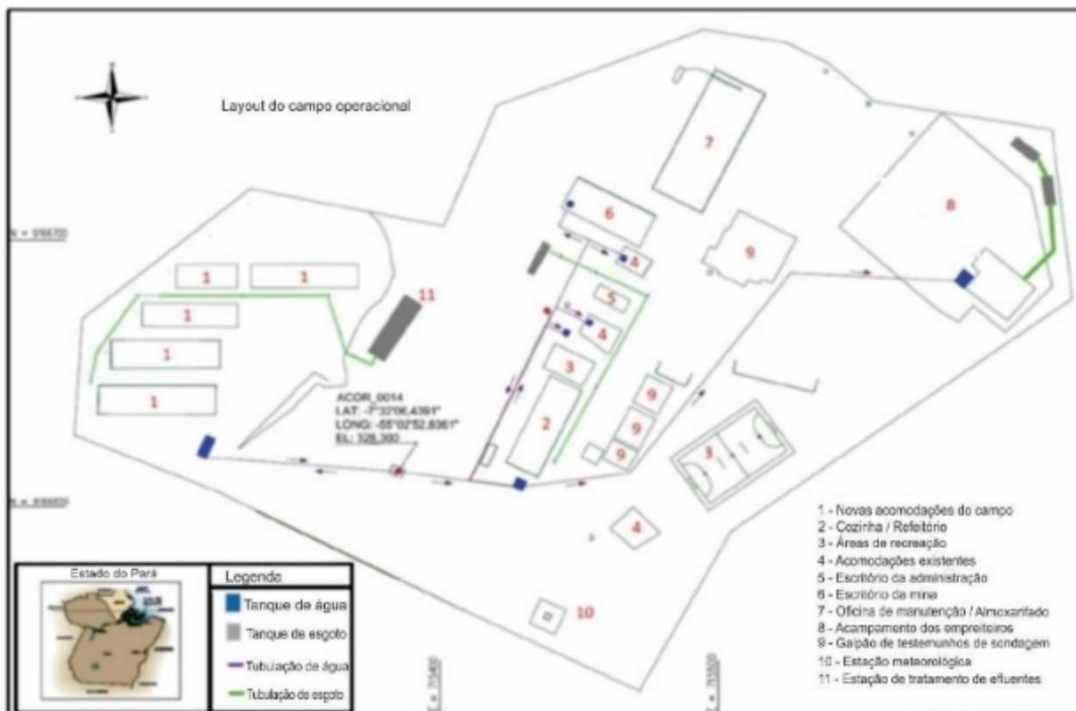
LAYOUT DAS INSTALAÇÕES.
